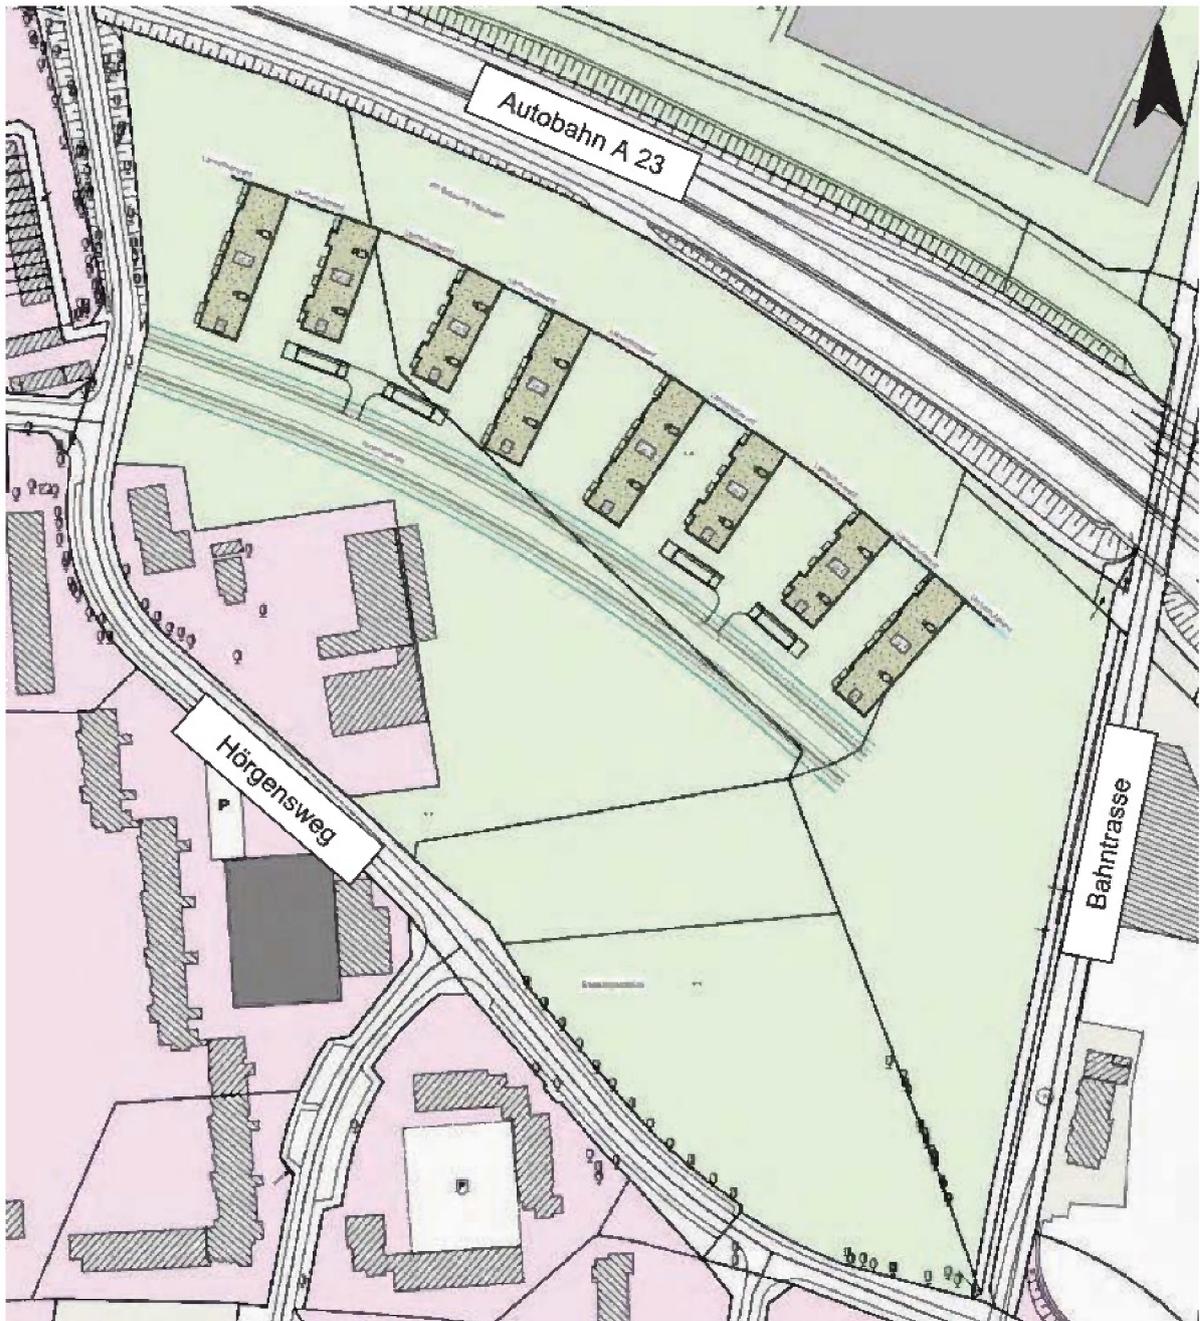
Übersichtsplan geplante Bebauung (1. BA)
